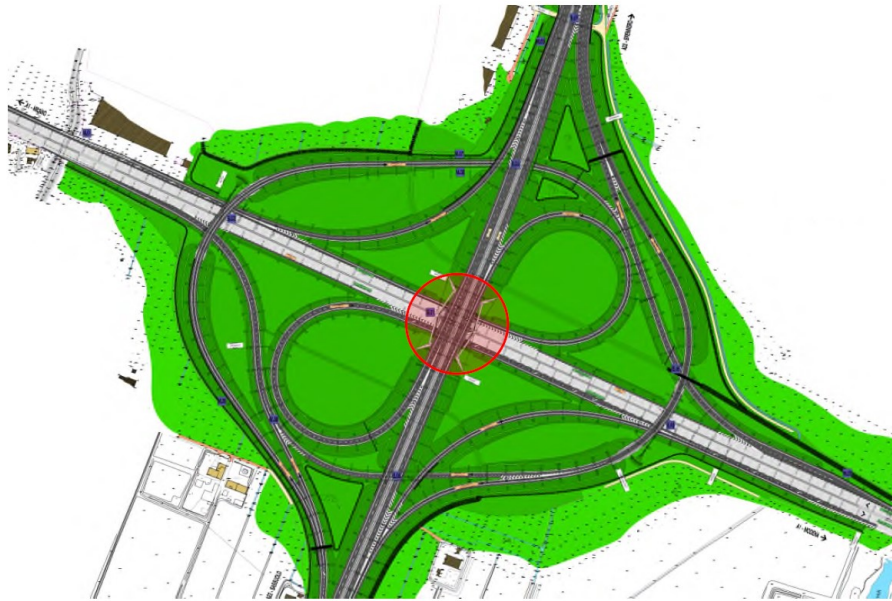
Planimetria di progetto del nuovo svincolo di interconnessione A22 - A1
